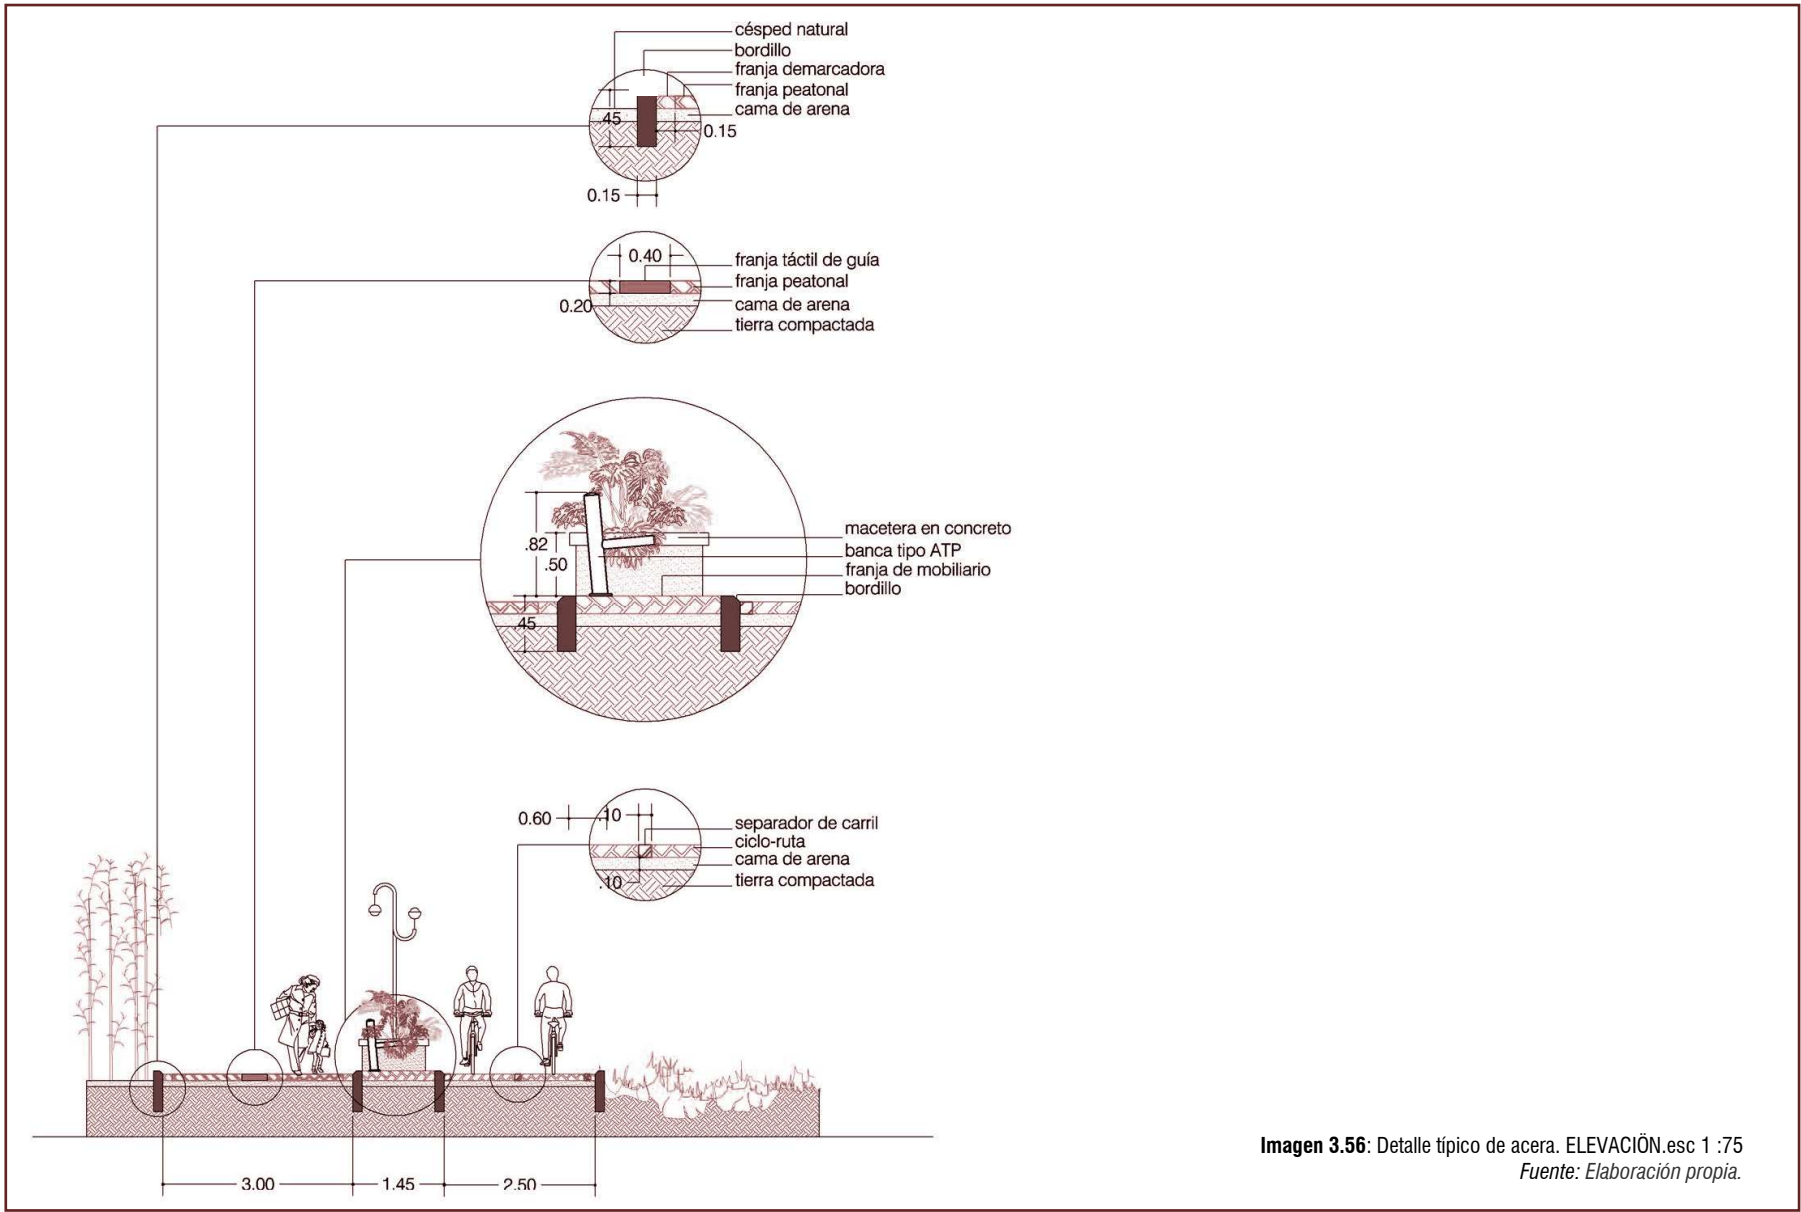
Detalle típico de acera. ELEVACIÓN.esc 1 :75
